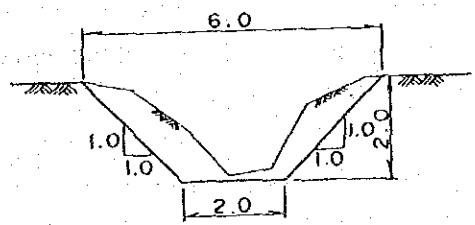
Sección Típica de Canal de Drenaje
